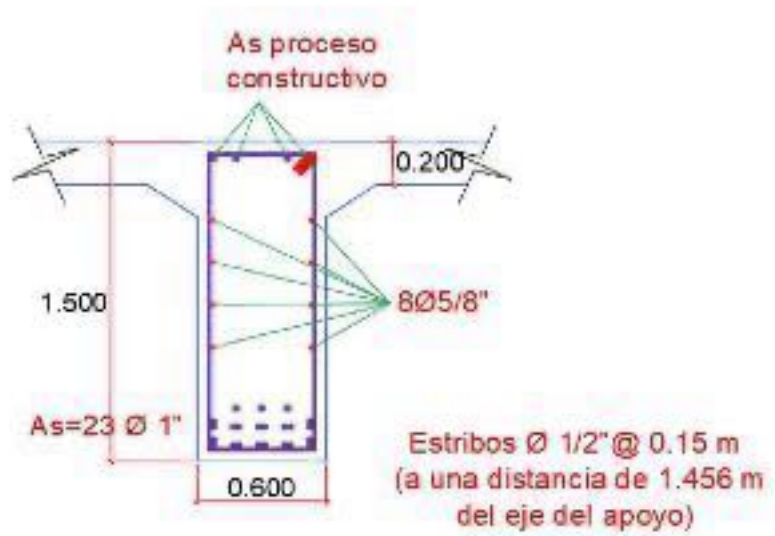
Armadura longitudinal y transversal en la viga interior.
